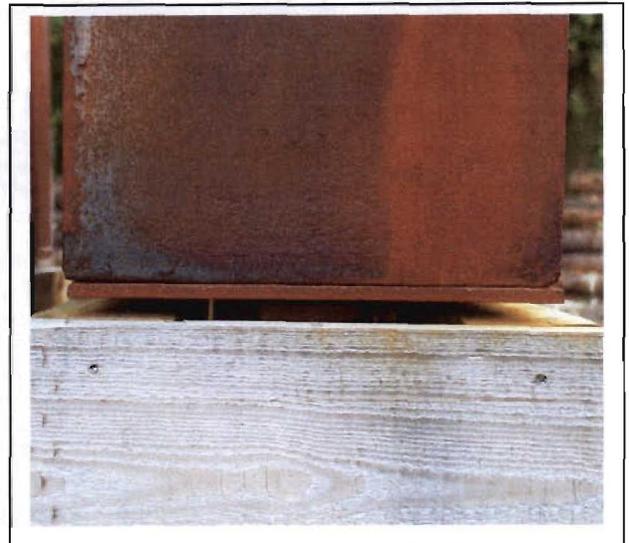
Positionierung des Wandelementes im Stellgerüst sowie des Prüfgewichtes auf dem Wandelement zum Stellgerüst
